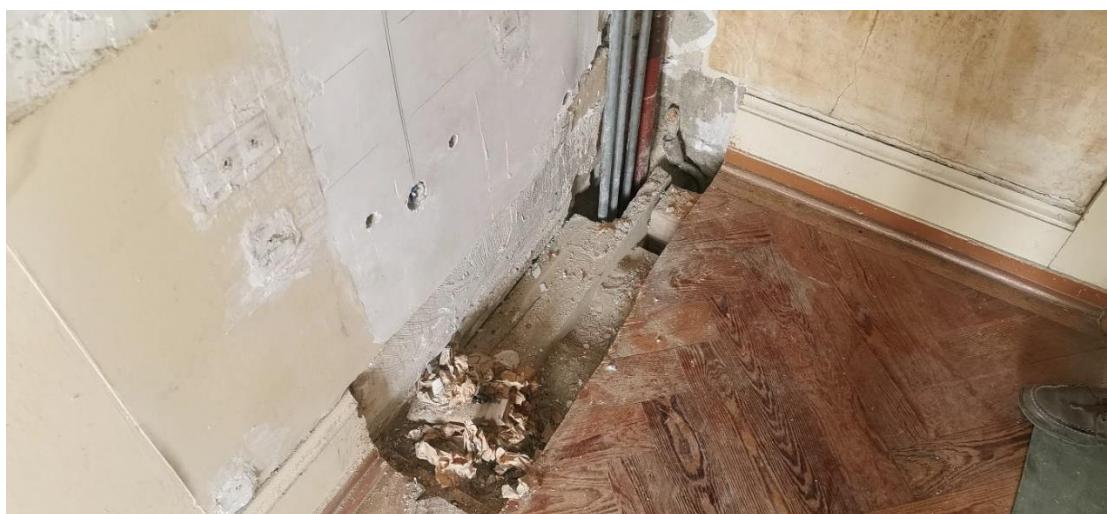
Poutres sectionnées et statique affaiblie 1
